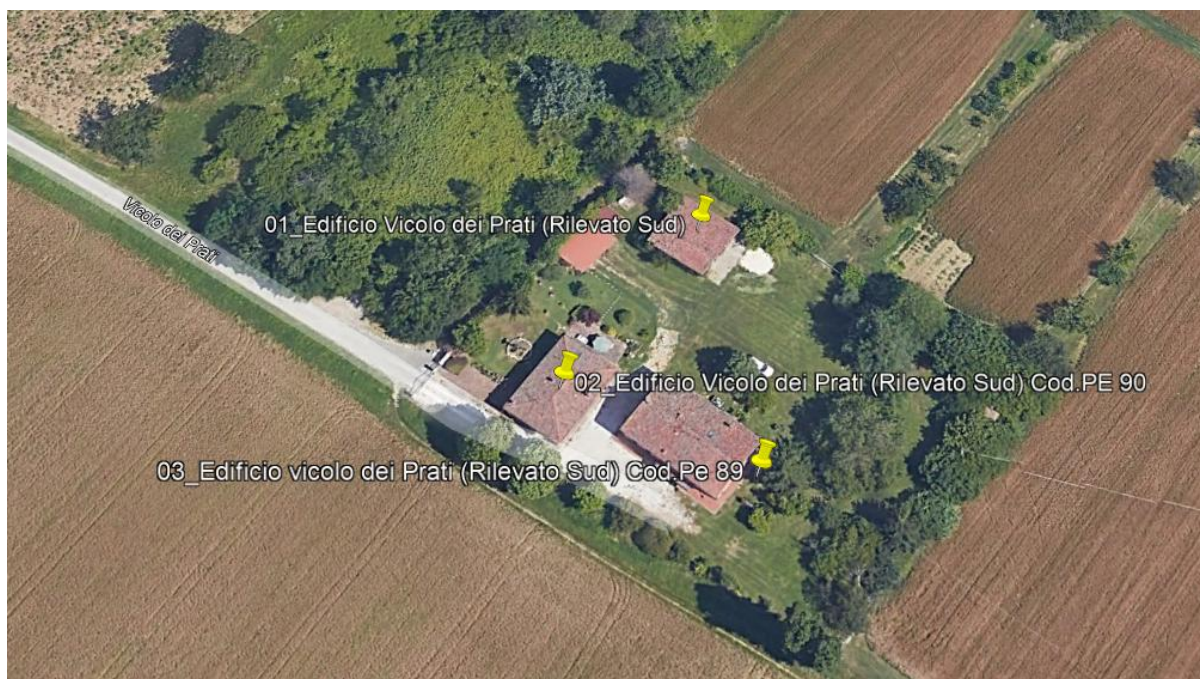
Edifici oggetto di monitoraggio in corrispondenza del rilevato Sud da Google Earth®
